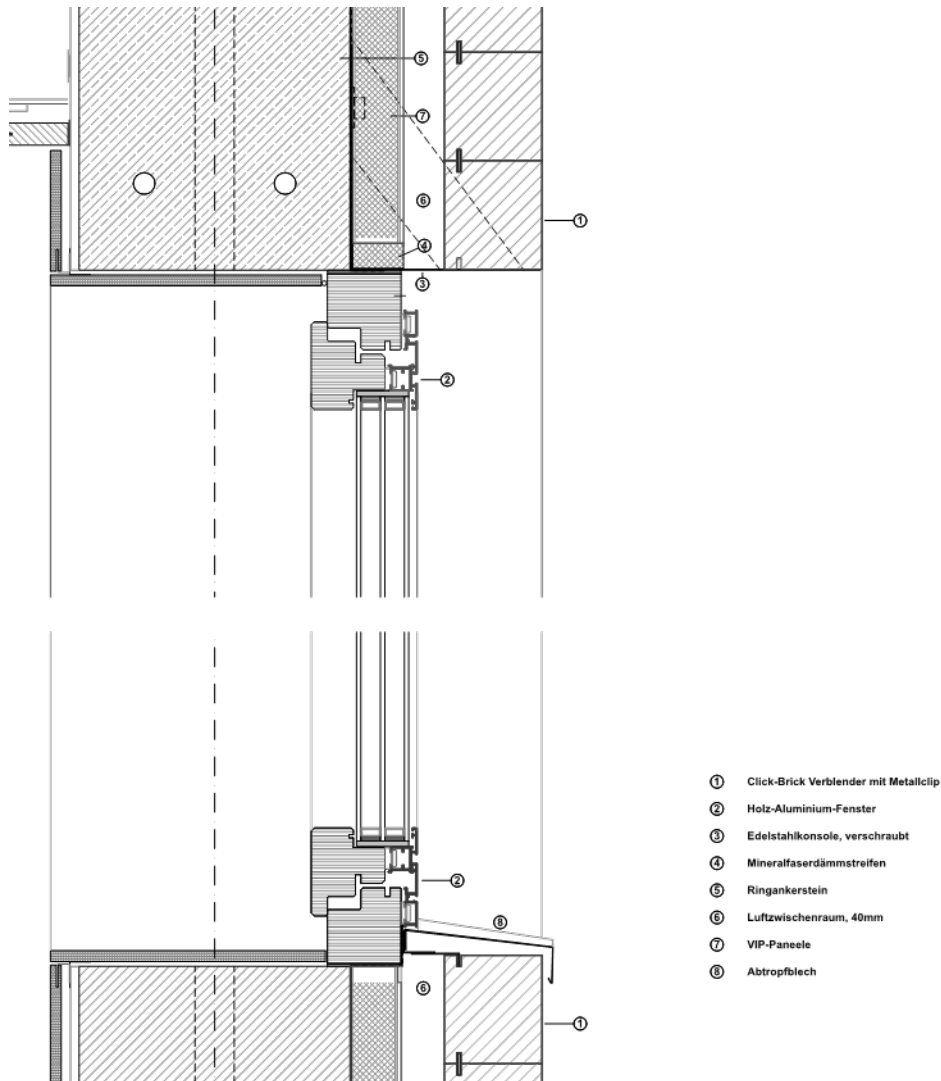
Fensteranschlussdetail bei Click Brick-Fassadensystem (Prinzipdarstellung)
